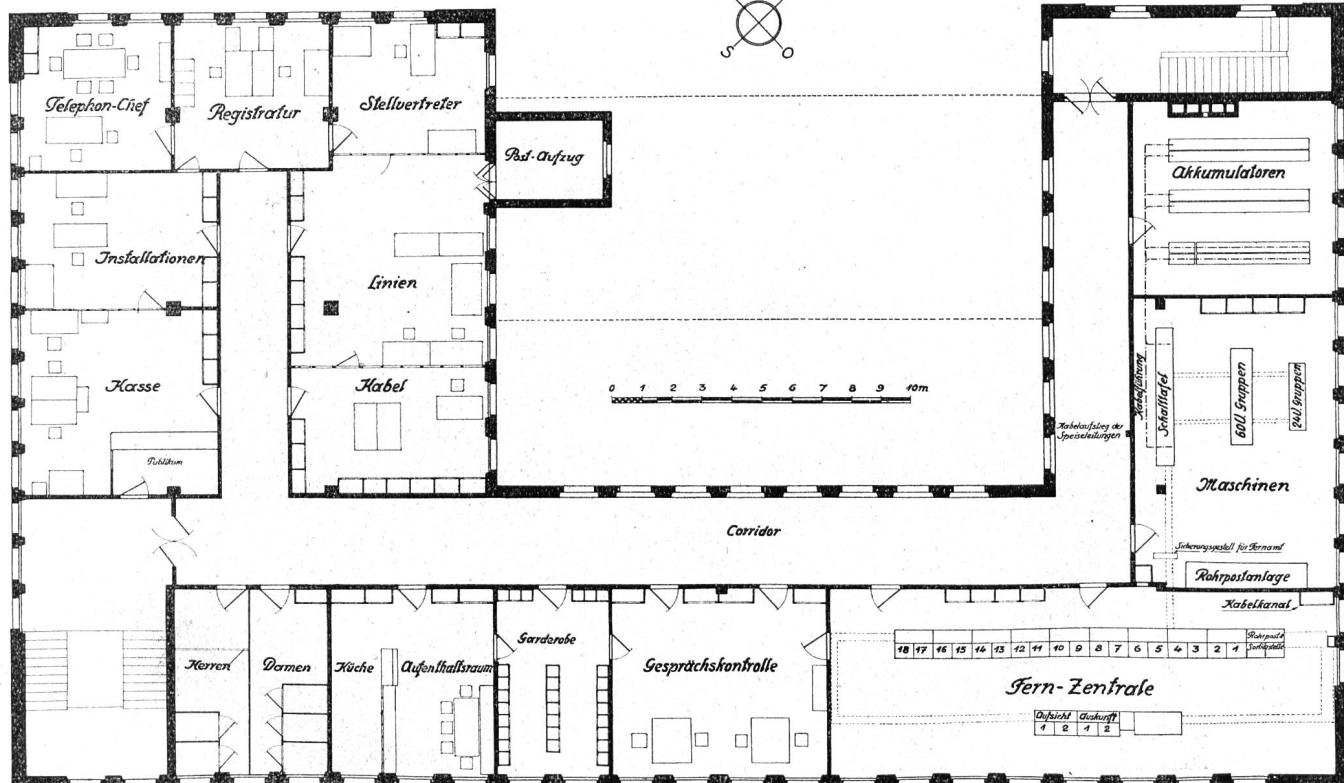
Grundriss des zweiten Stockwerkes. — Plan du deuxième étage.
